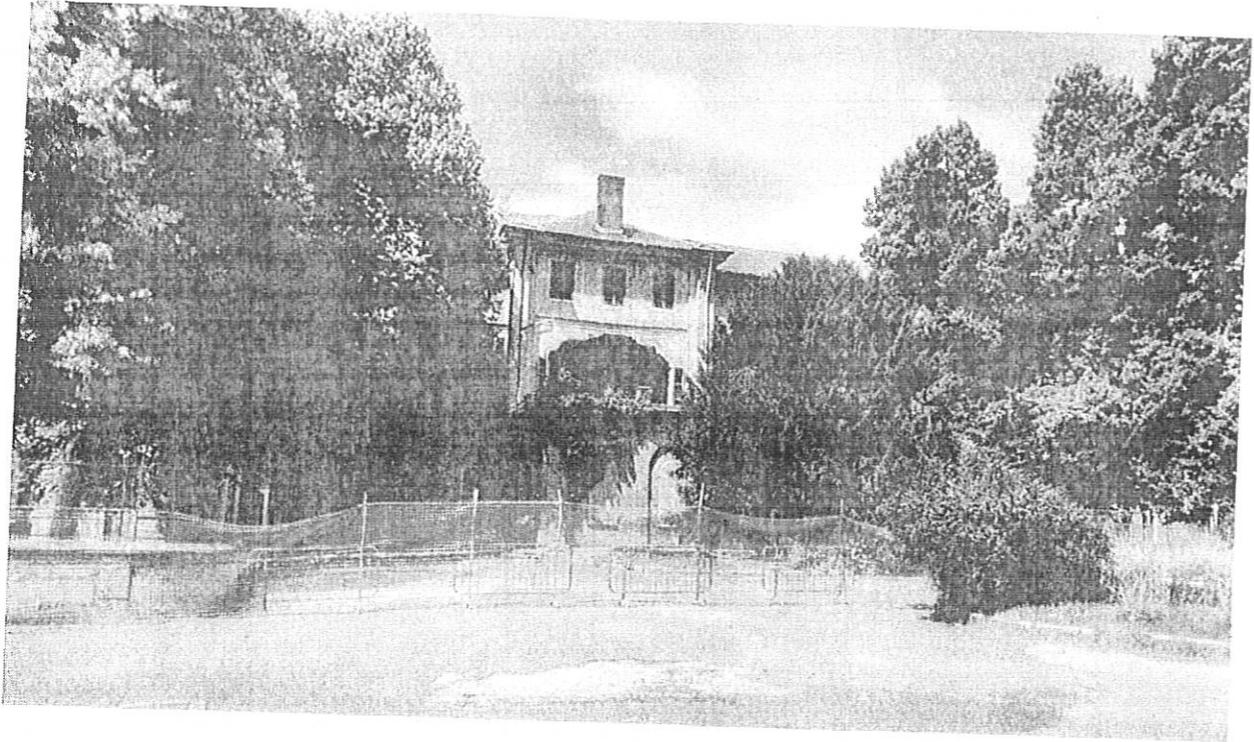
Vista dell'avancorpo centrale sud, con la parte crollata
